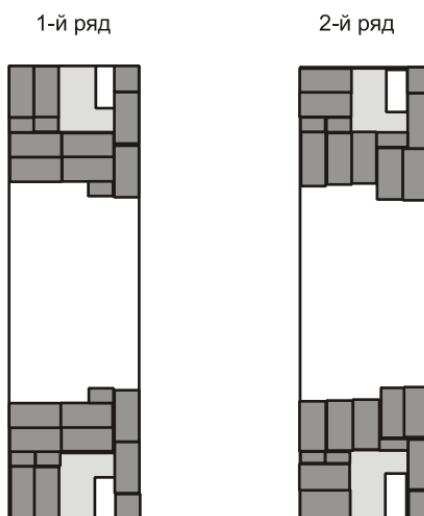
Схема кладки оконных проемов при колодцевой кладке
